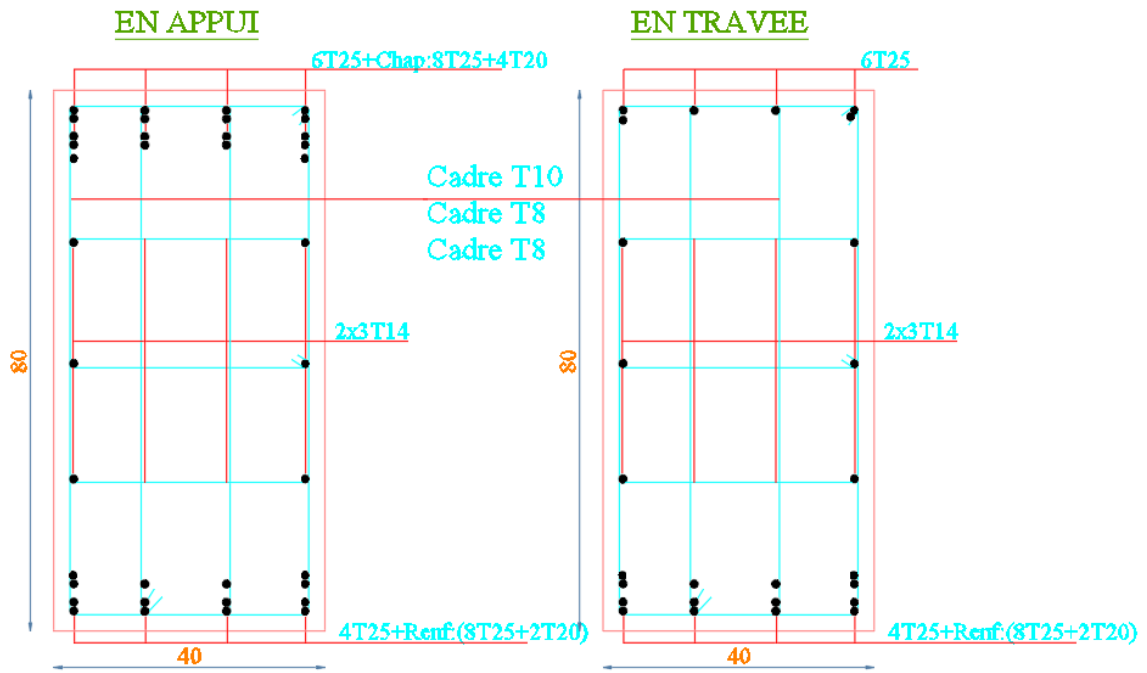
Schéma du ferrailage de la poutre secondaire 40*80
